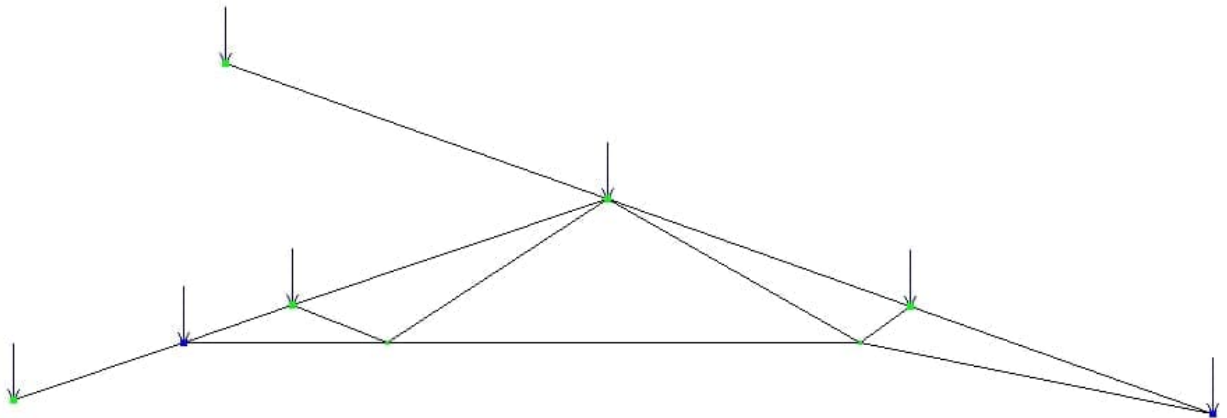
Розрахункова схема ферми прольотом 18,7 м
